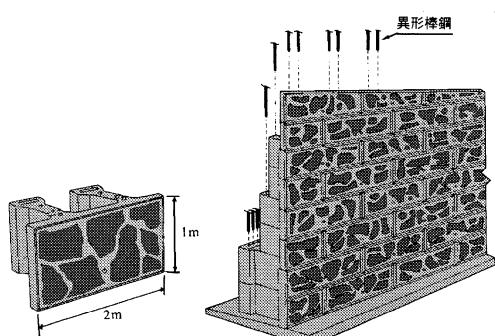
典型的なプレキャストコンクリート擁壁部材とその施工システム
